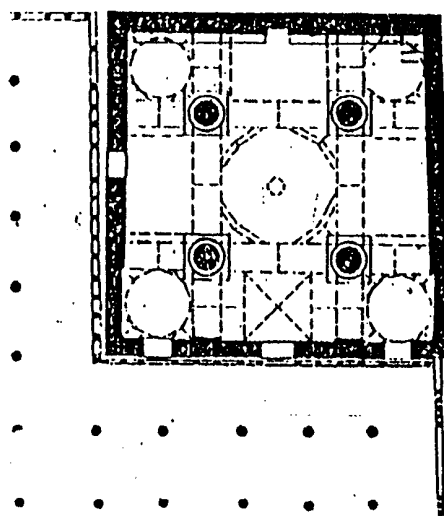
مسقط أفقي لجامع السليمانية في استانبول (عن : Gabriel)
